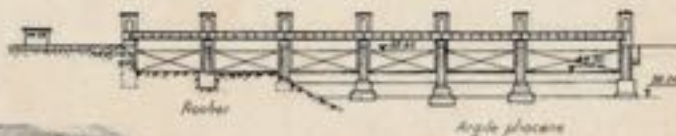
Barrage de retenus. Coupe transversale d'une passe.
